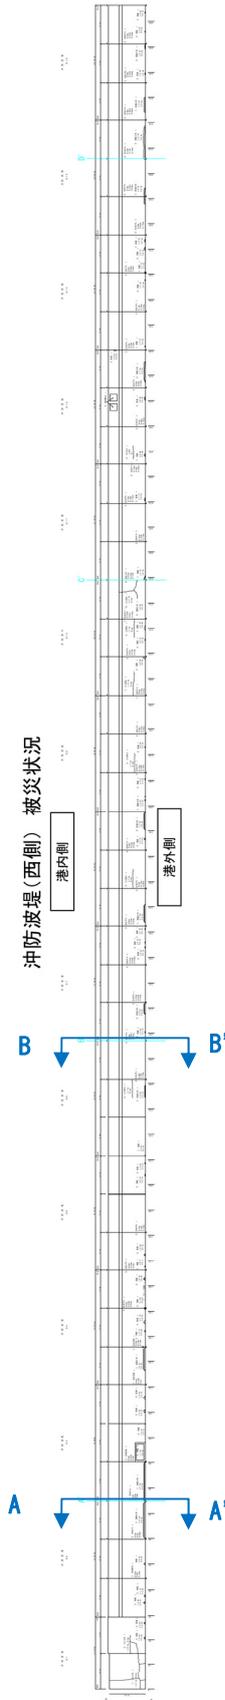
仙台港区\_外港地区\_沖防波堤の平面図(西側) (被災後)
